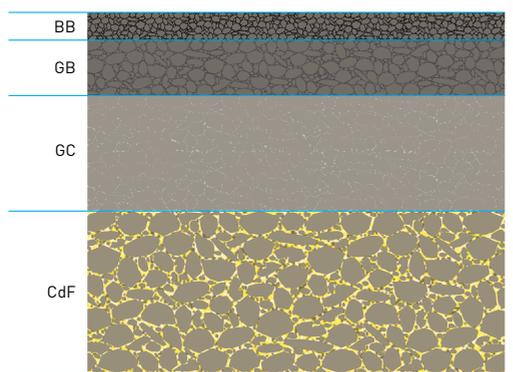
Coupe en travers-type BB/GB/GC/CdF -
